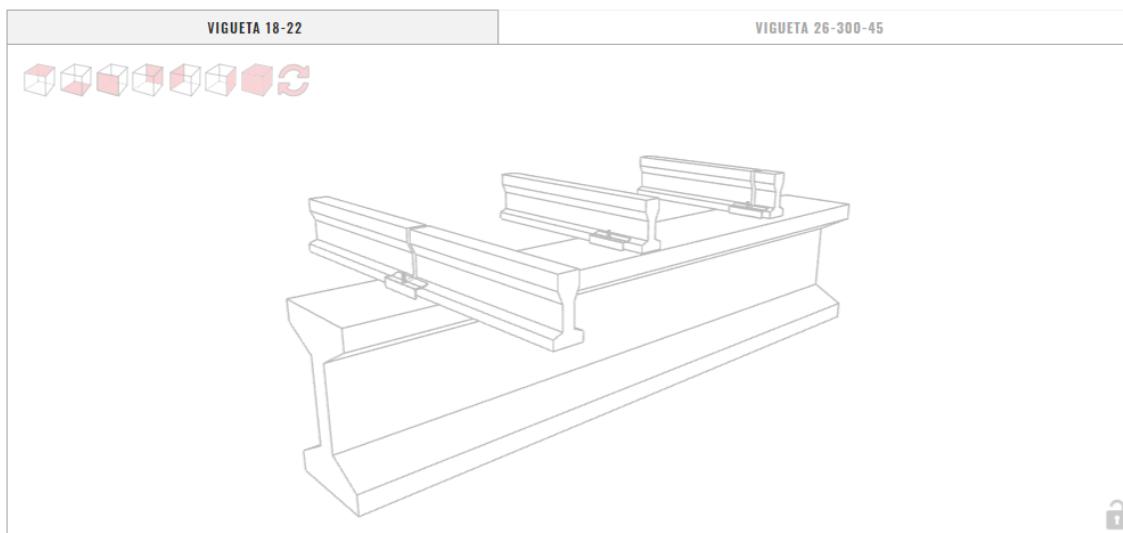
Detalle constructivo de la unión vigueta-viga [11]
